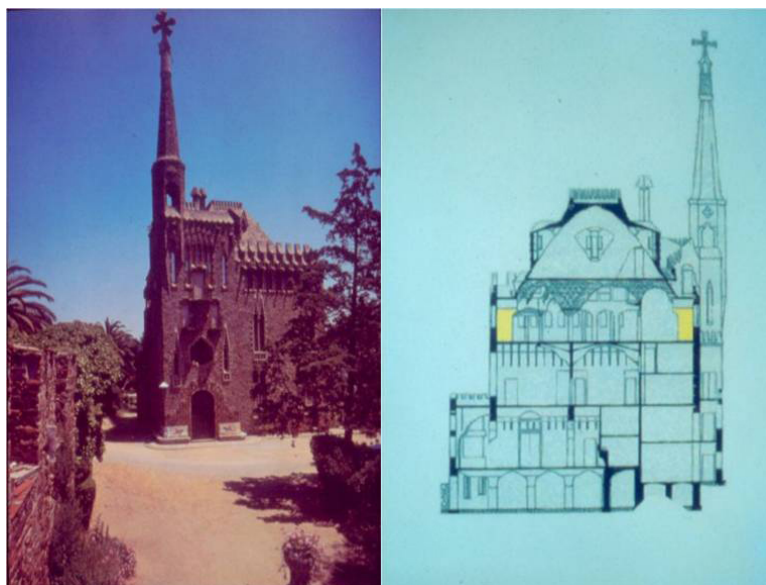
Bellesguard (a) Vista exterior (b) Sección central
